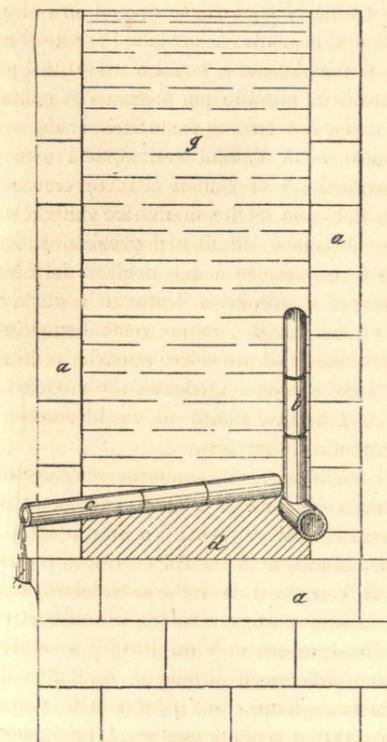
FIG. B. — Camera filtrante col rubinetto galleggiante e tubo collettore d'acqua filtrata.
